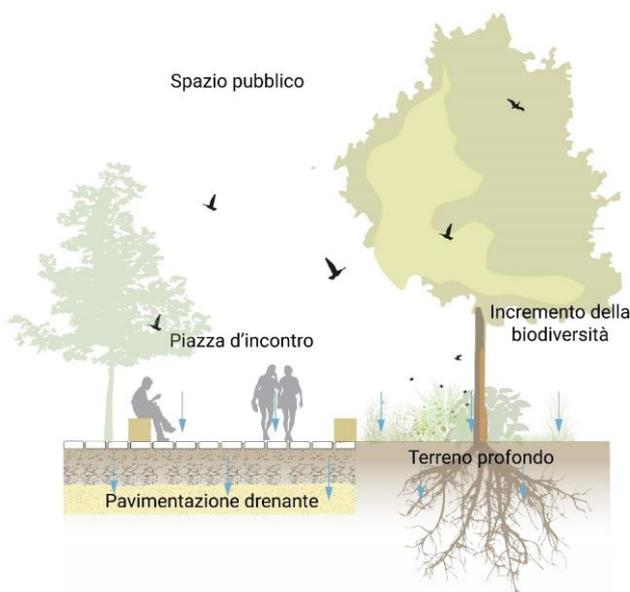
Superfici pavimentate drenanti per favorire l'infiltrazione naturale delle acque piovane
